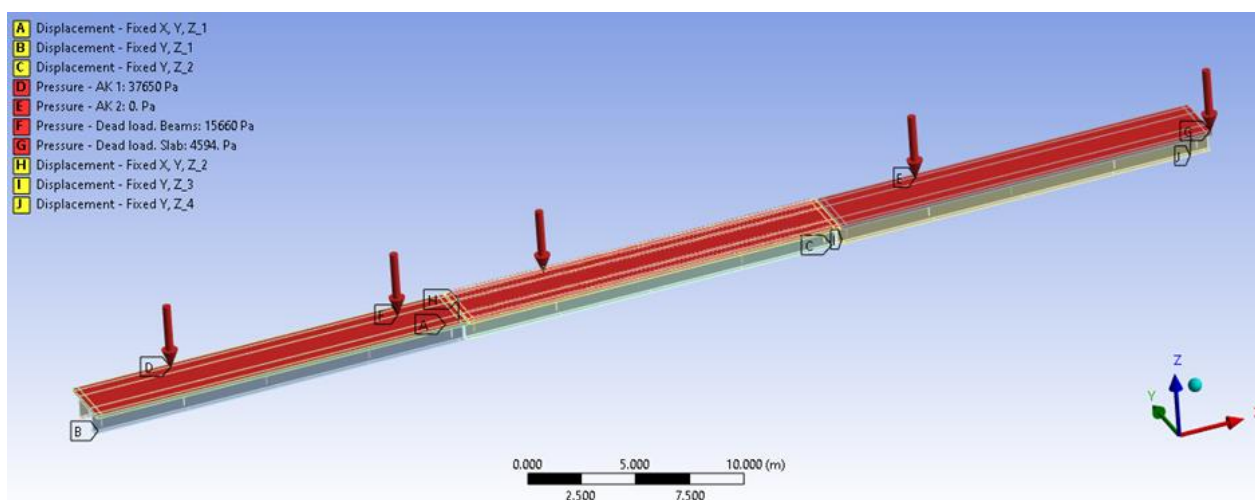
Розрахункова схема трьохпрольотної прогонової будови з залізобетонною плитою
